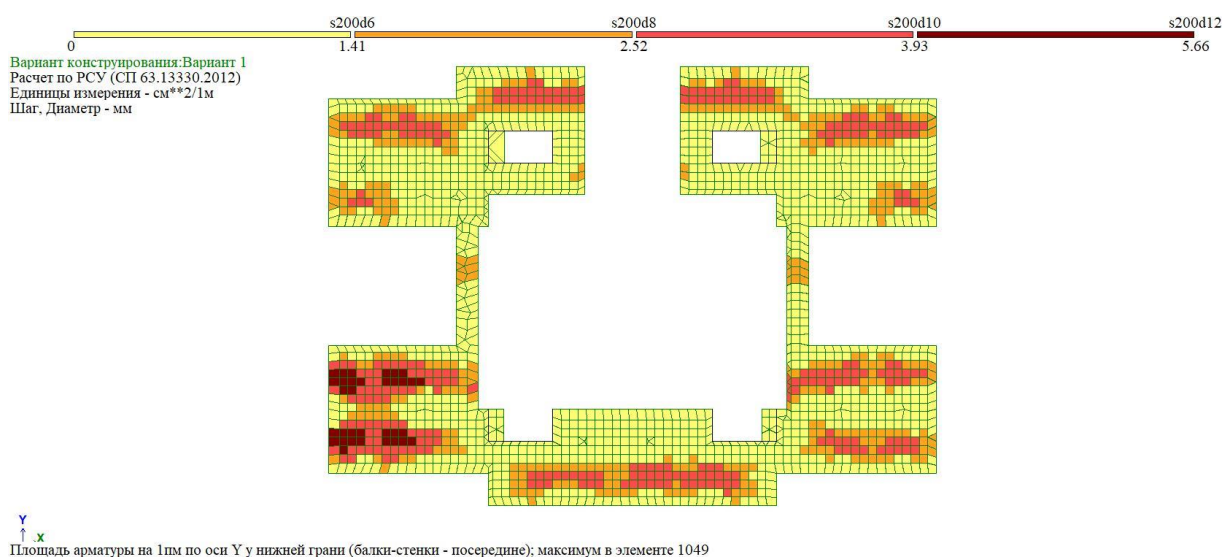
Нижняя арматура в плите перекрытия вдоль оси Y
